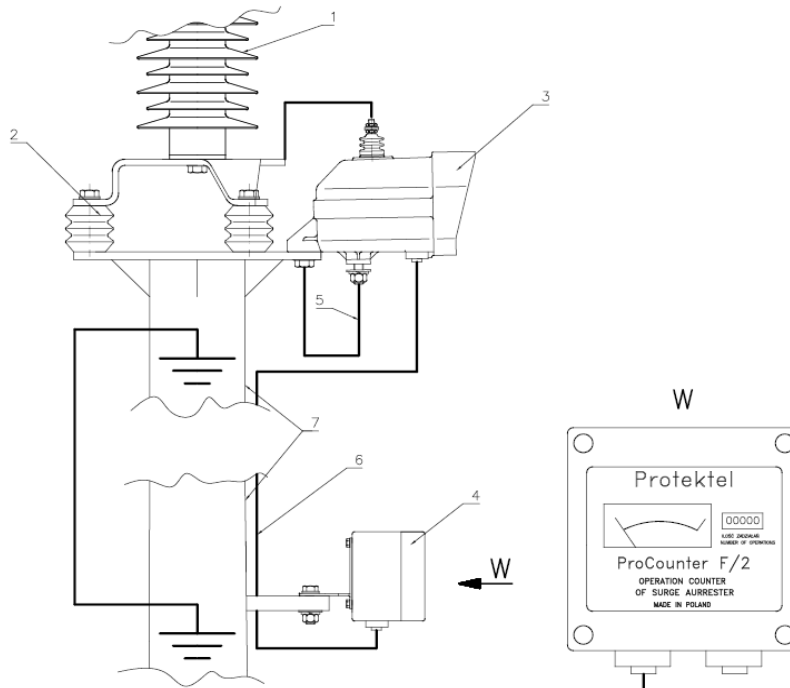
Sposób montażu licznika zadziałów typu ProCounter (A; B; C; D; E)
